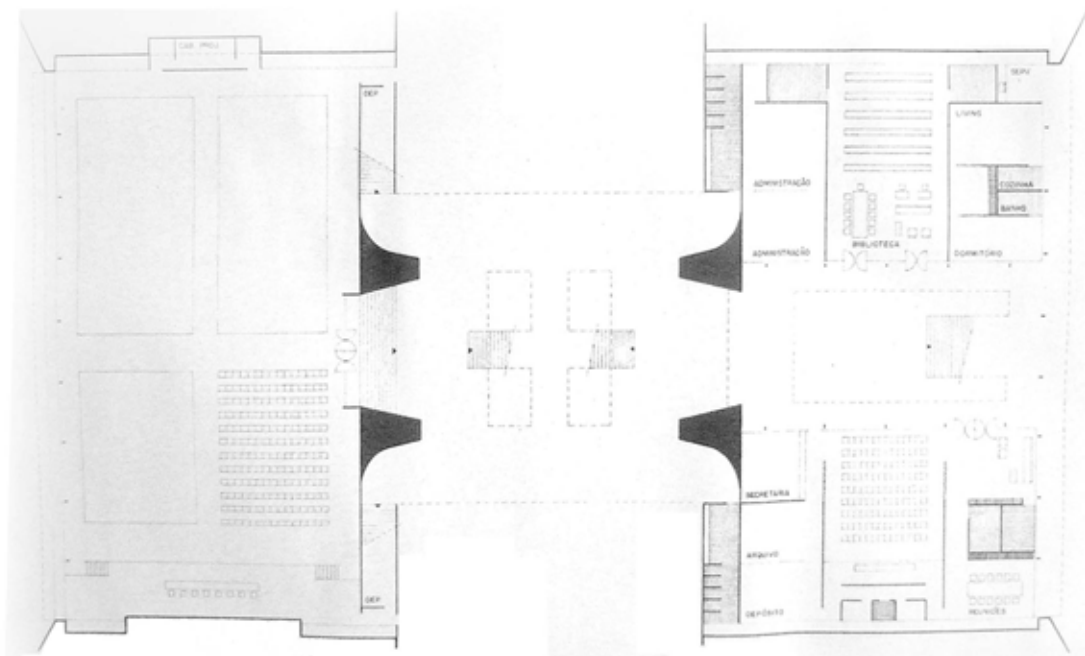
Museu Pedro de Toledo - Planta T rreo
